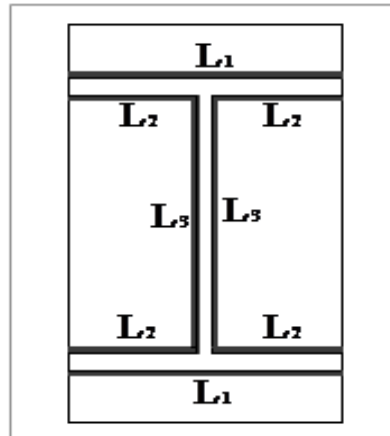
Dispositions de cordons de soudure(poutre platine)
